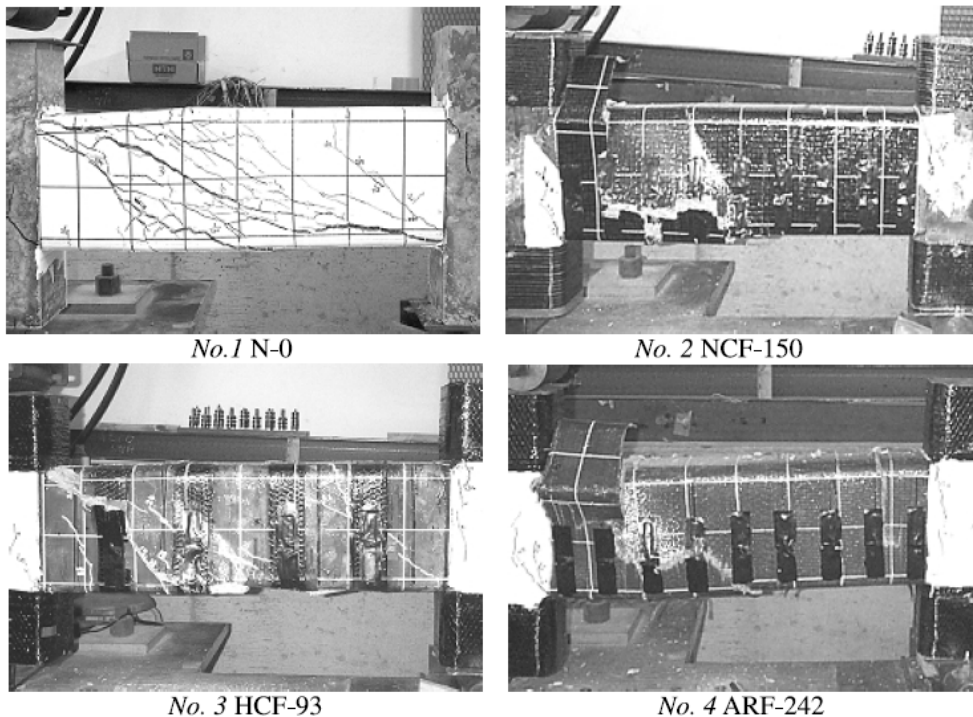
Padrão de fissuração das vigas ensaiadas (KANABUKO *et al.*, 2001).
